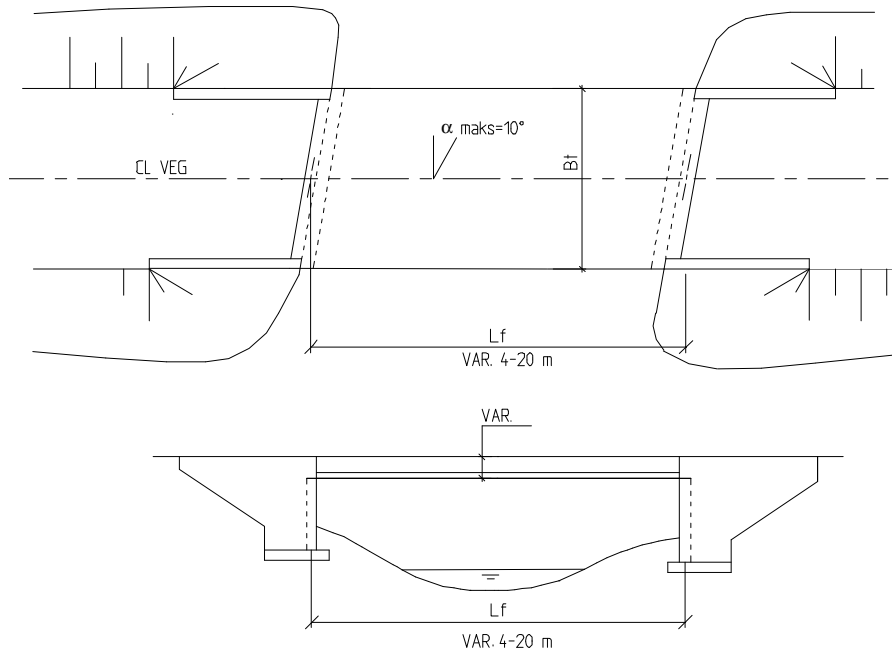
Plan og oppriss, ettspenns platebru. Kantdetaljer er ikke vist
